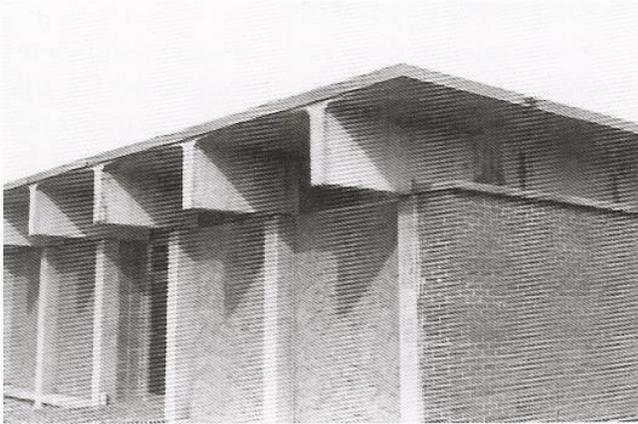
La mayoría de los techados de hormigón son prefabricados.
